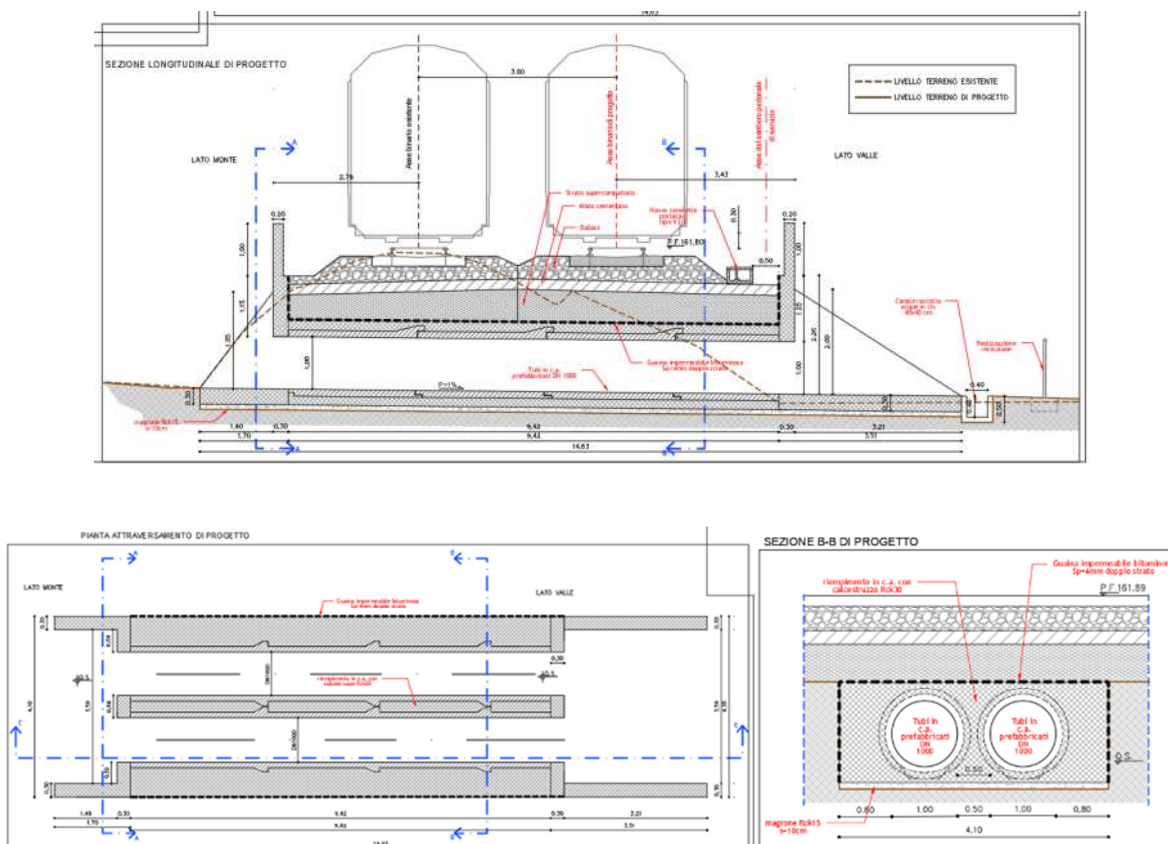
Pianta, Sezione e Profilo longitudinale tombino km 19+068,98
